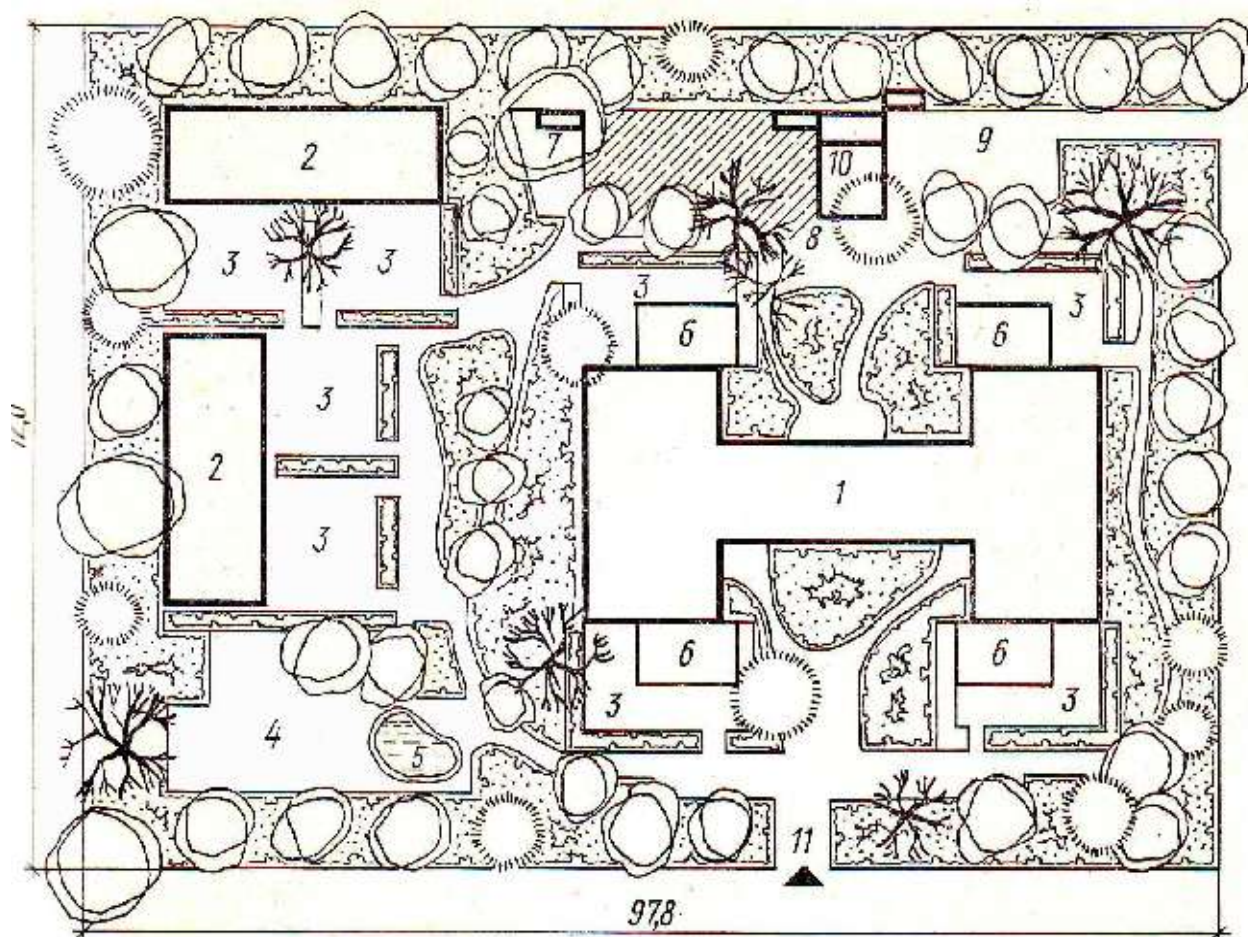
Генеральный план участка детсада на 90 мест: 1 — одноэтажное здание детского сада; 2 — летний павильон; 3 — игровая площадка; 4 — физкультурная площадка; 5 — плескательный бассейн; 6 — тентовый навес; 7 — живой уголок; 8 — огород; 9 — хоздвор; 10 — сарай; 11 — главный вход
